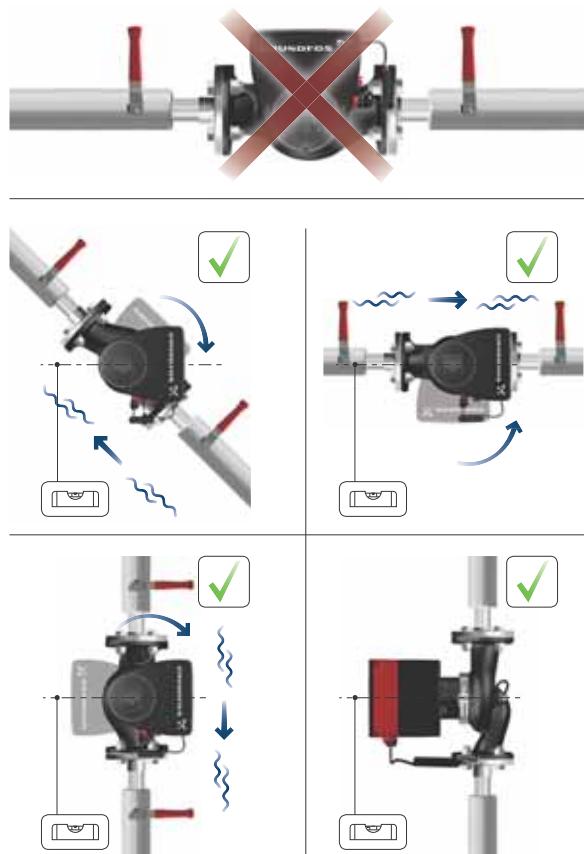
Čerpadlo instalované s horizontálním hřidelem motoru
